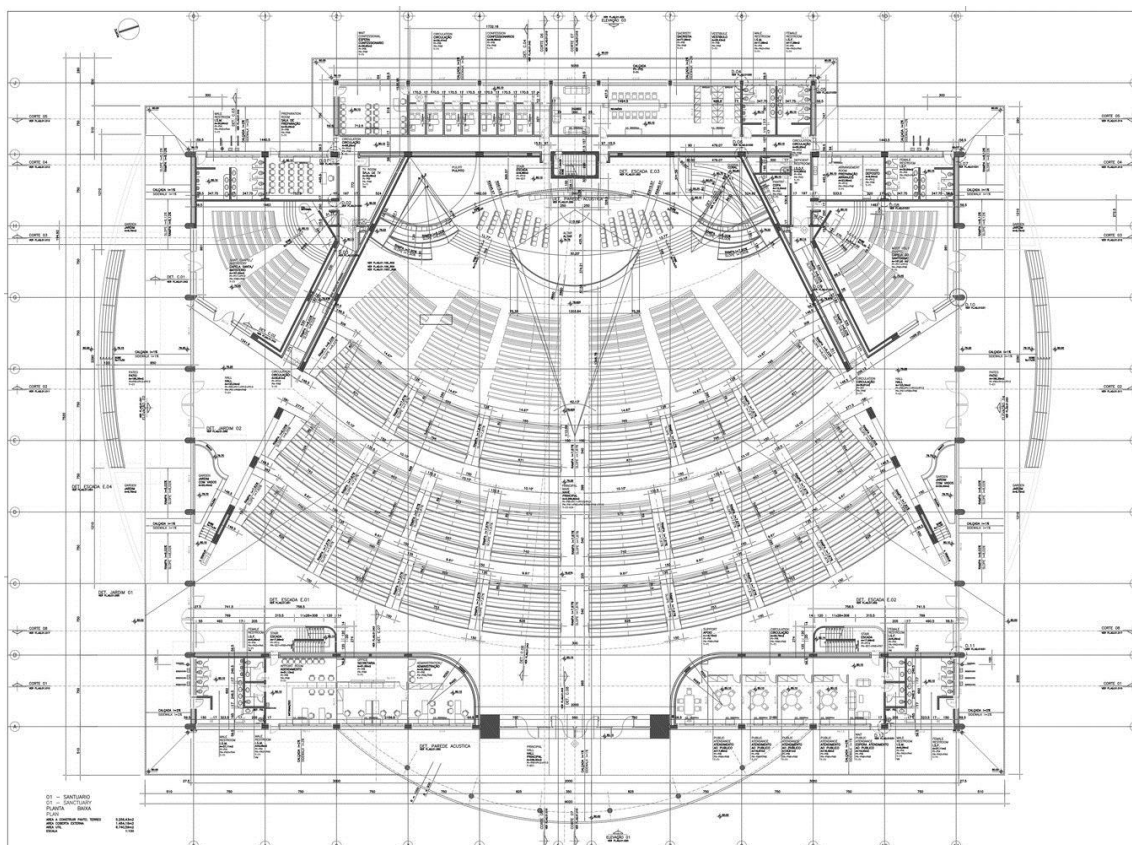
Planta baixa do templo do Santuário Santa Paulina. Fonte: HS Arquitetos
